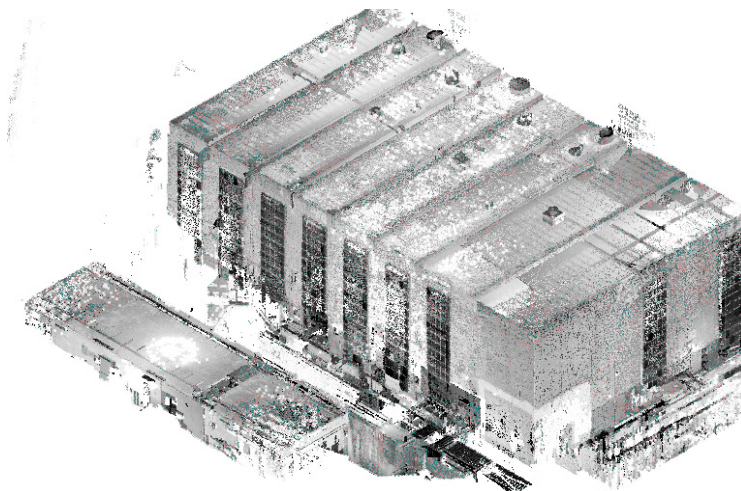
Vista prospettica delle nuvole di punti in ambiente BIM.
